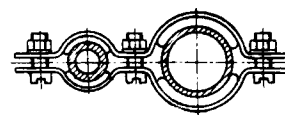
Крепление трубопроводов обоймой с прокладками.
